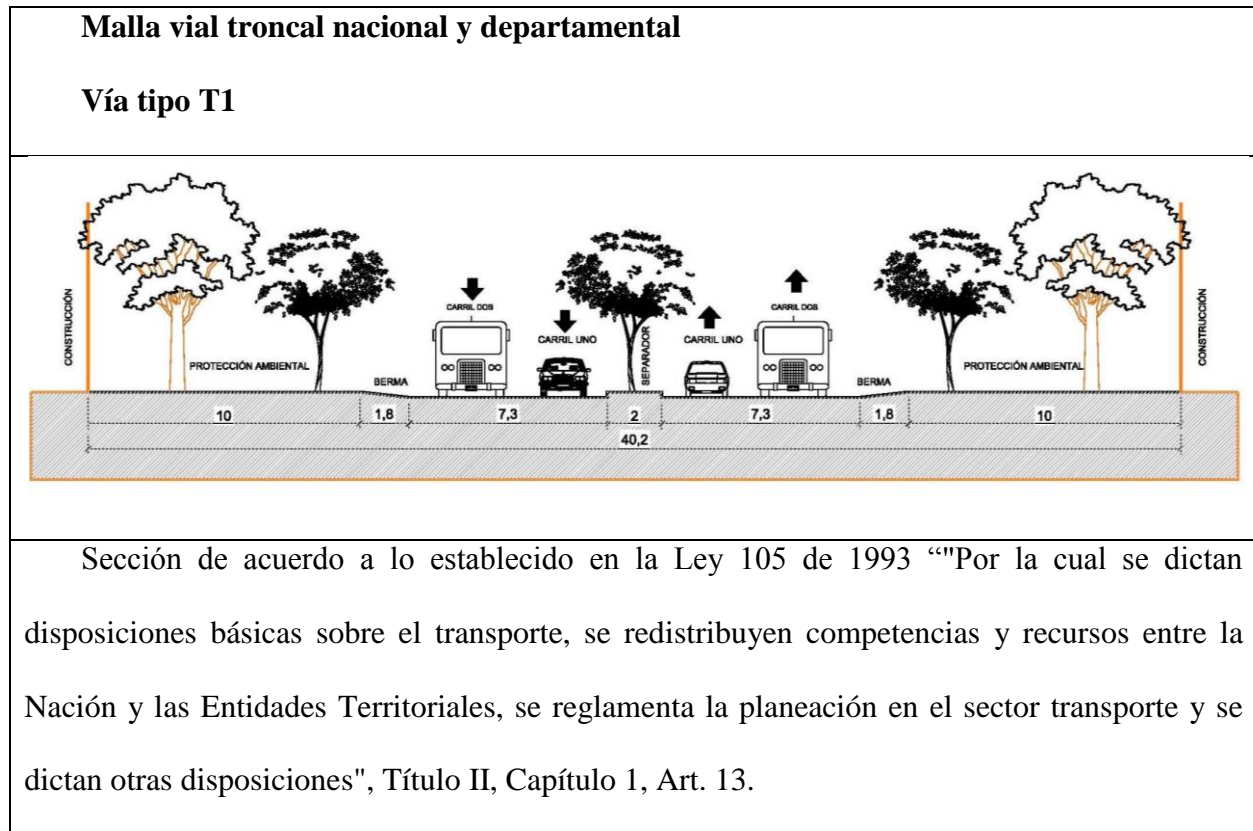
Perfil vial tipo T1. Fuente: POT Barrancabermeja.
